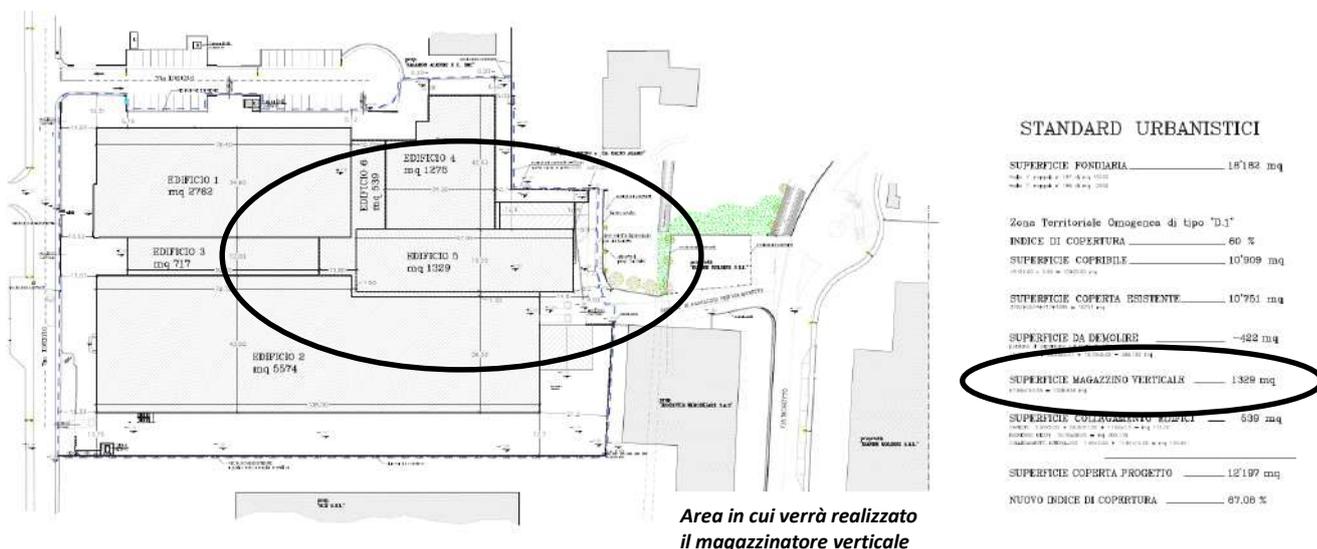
Inquadramento e Planimetria ampliamento struttura produttiva in progetto
